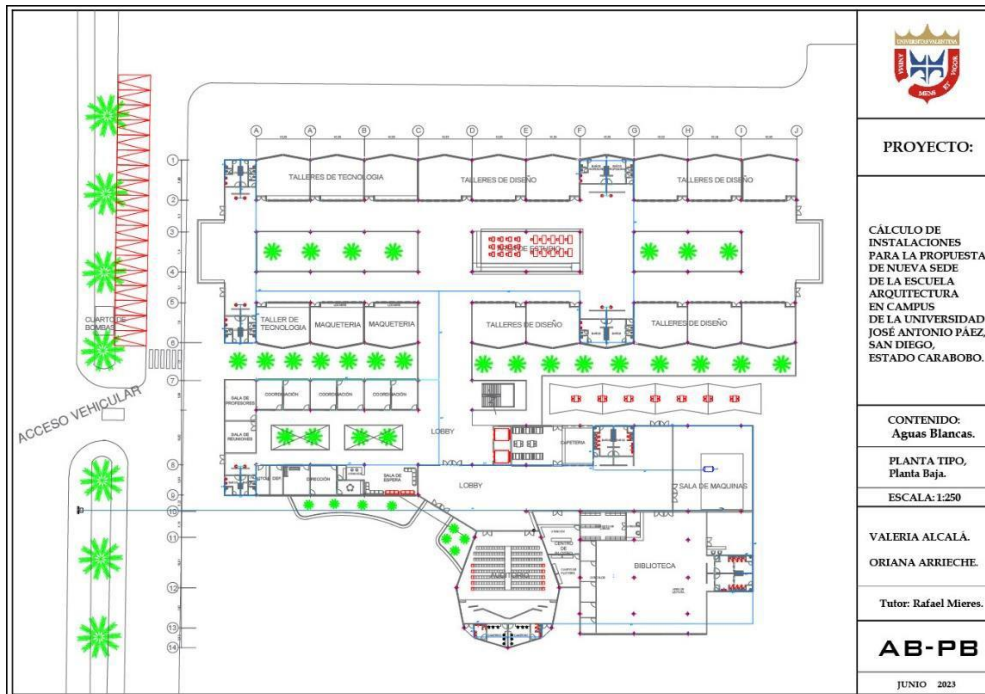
Distribución de red de aguas blancas planteada para la planta baja.
